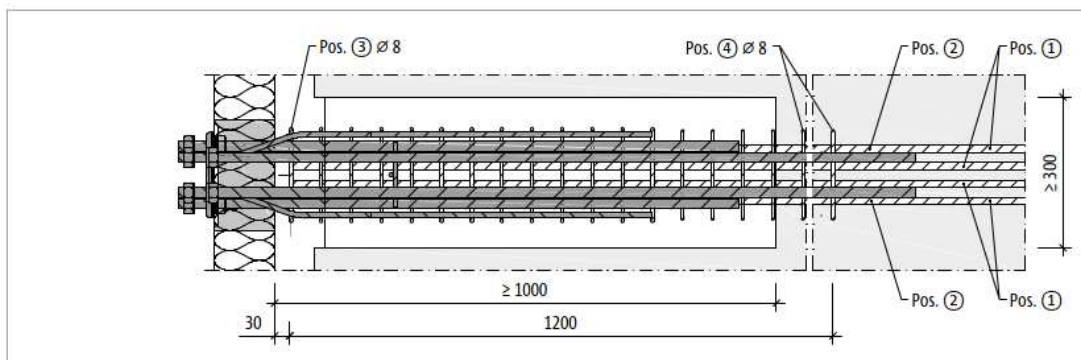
Schöck Isokorb® XT Typ SK-MM2: Bauseitige Bewehrung bei Halffertigteilbauweise, Grundriss
